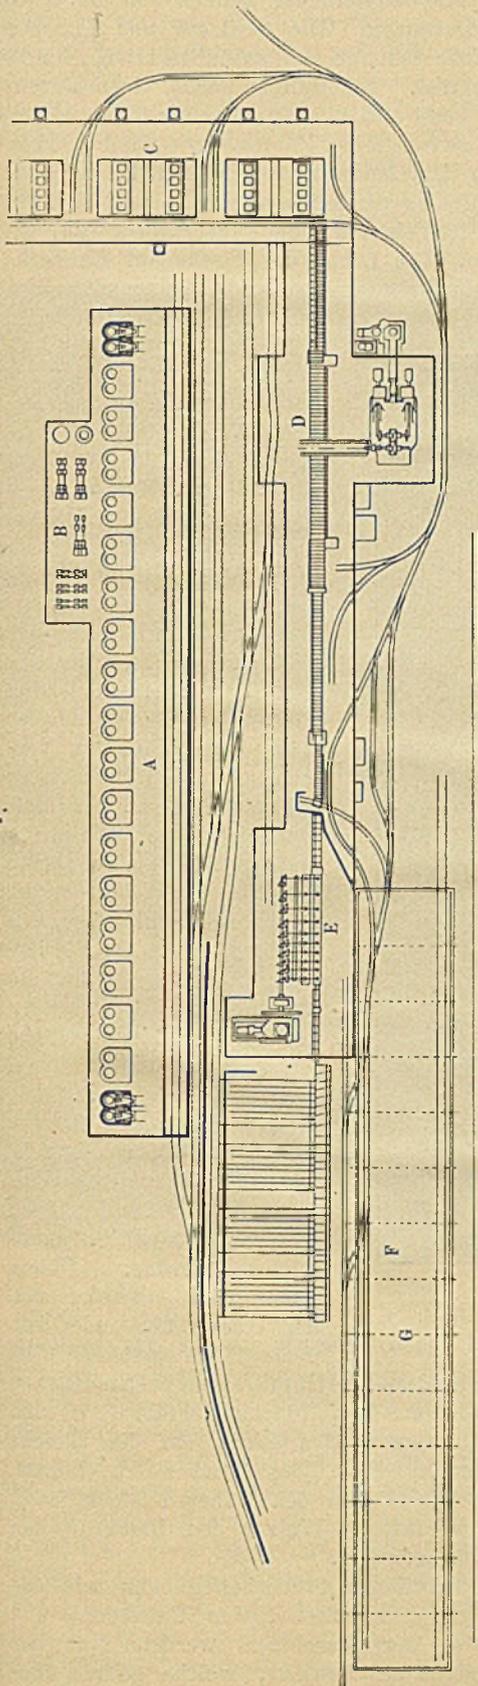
Lageplan der 40'' Block- und der sich daran anschließenden 14'' Feinstrafse.
